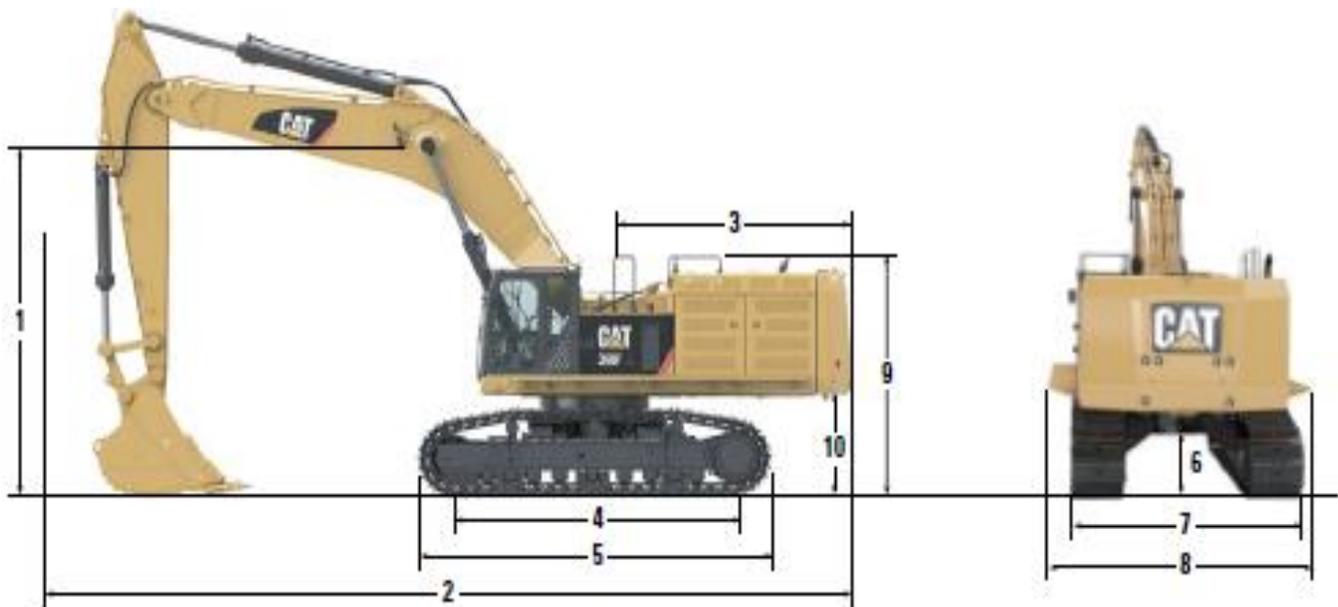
Dimensions Pelle Hydraulique CAT 390F
